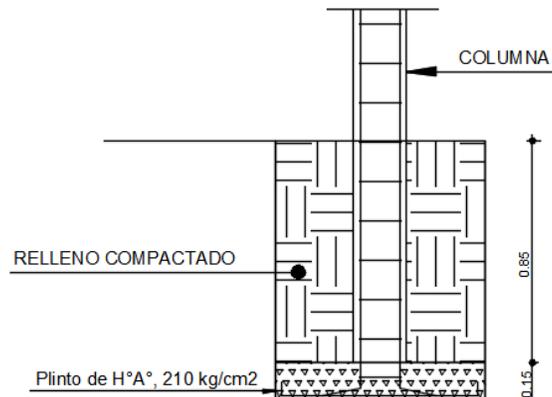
Detalle plinto vivienda tipo proyecto "Nulti".
